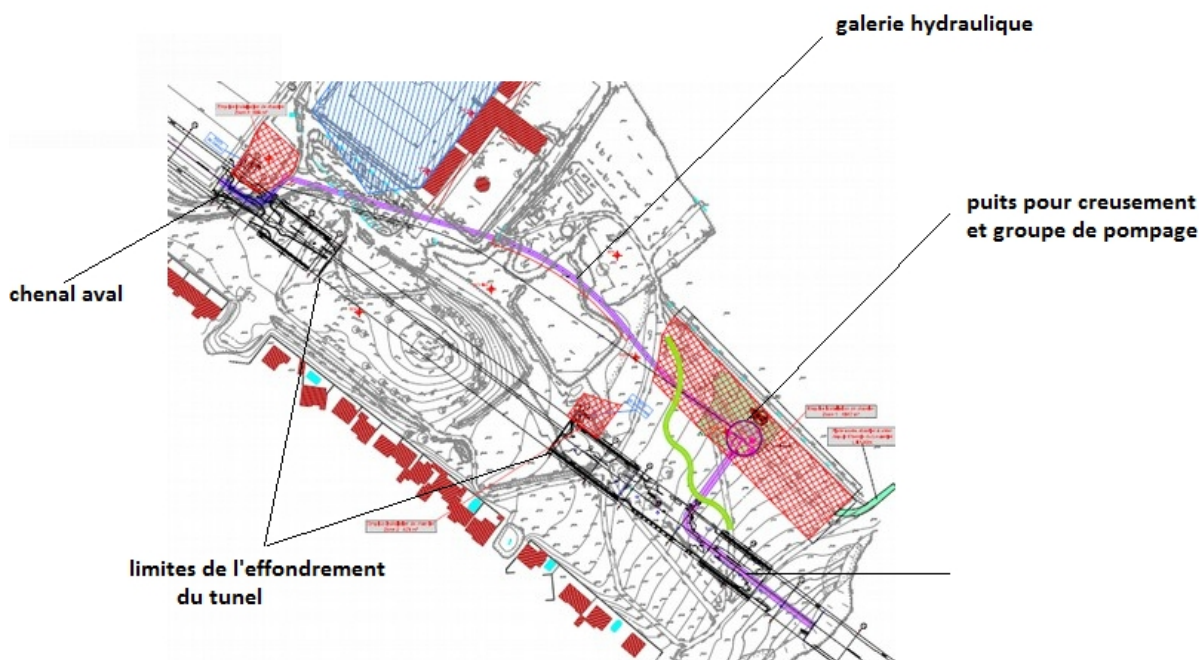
Plan du projet de base d'ouvrage hydraulique
